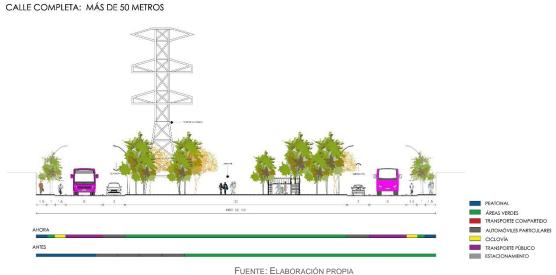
Propuesta de calle completa con sección vial de 50 metros
